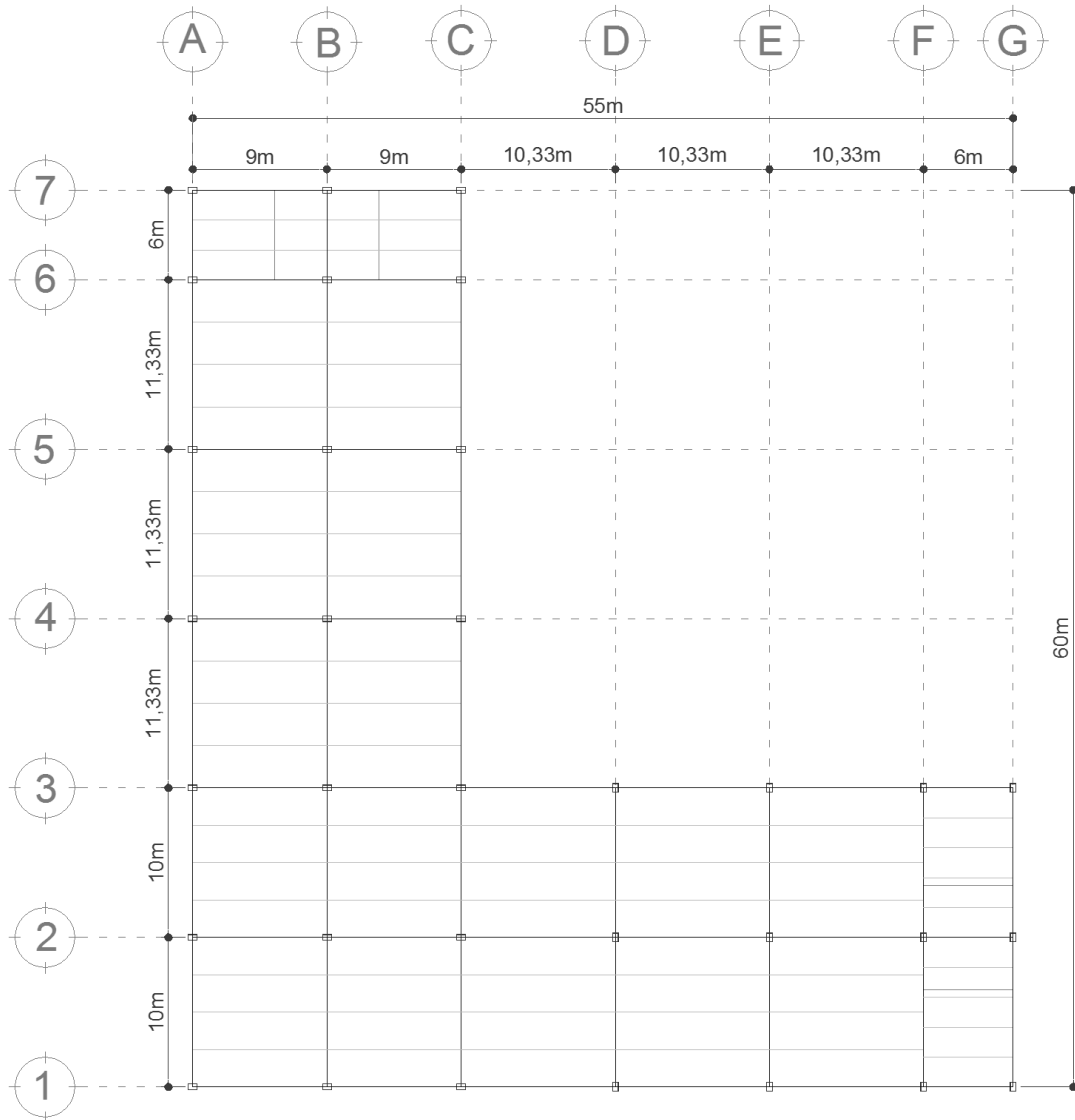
Columnas propuestas del nivel 6 al 10 para la estructura de acero.
